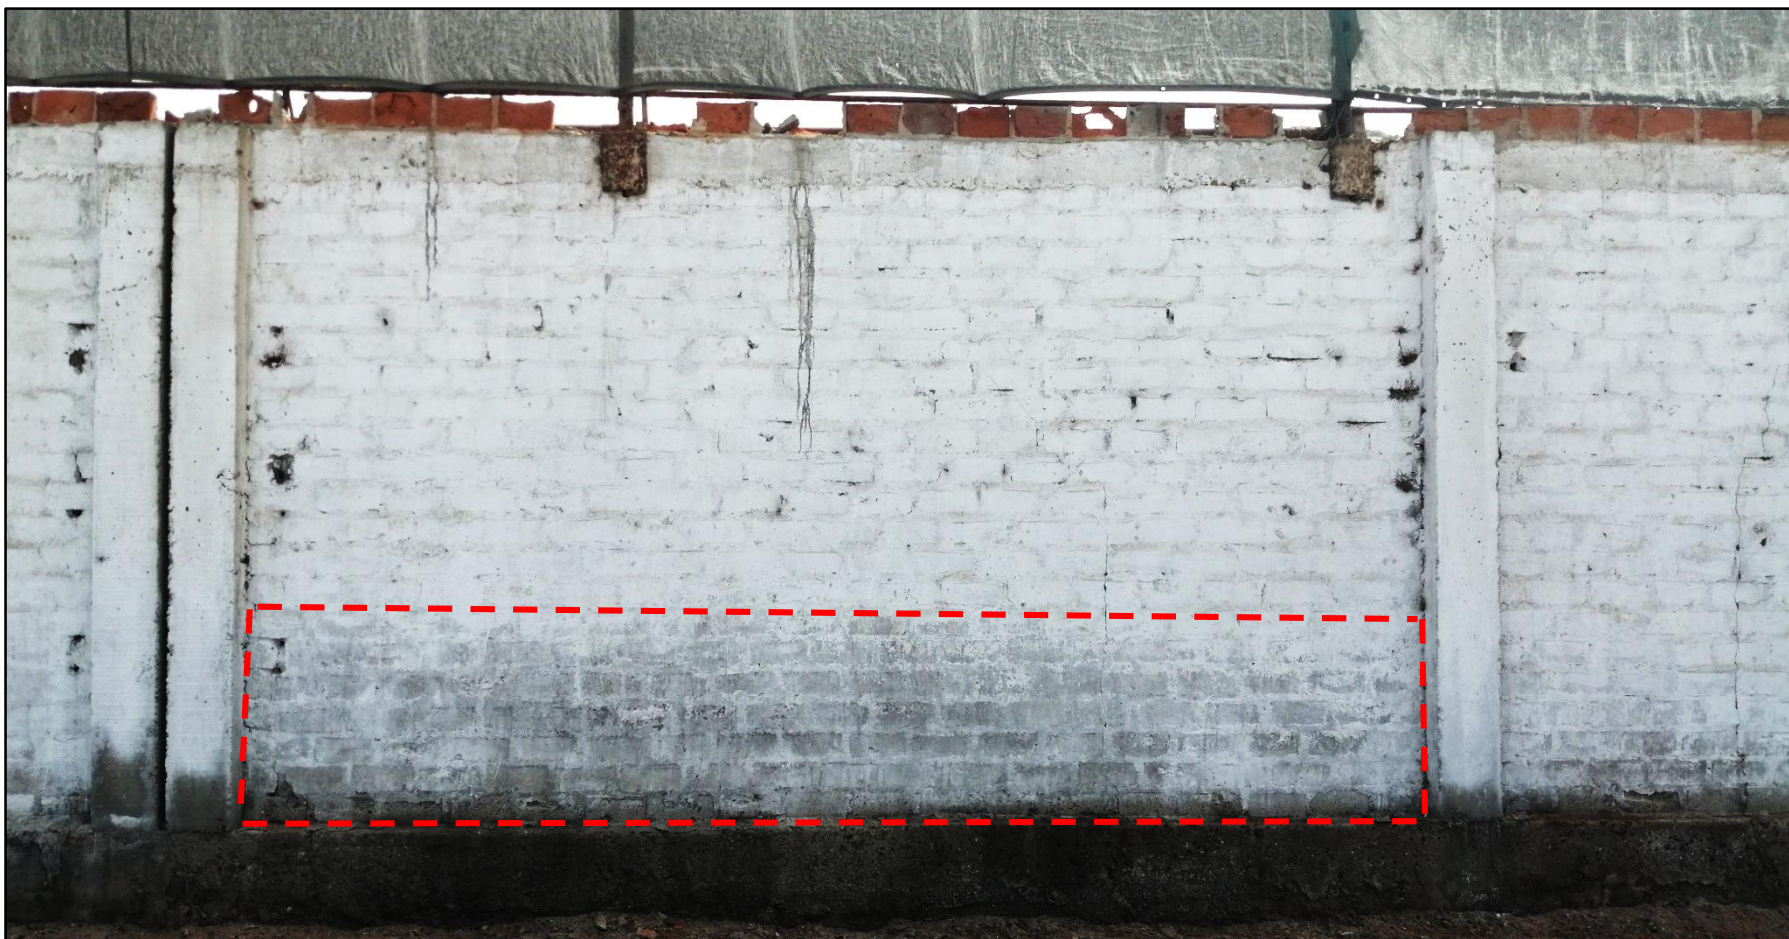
Muro de albañilería afectado por la eflorescencia en la UM-05.
